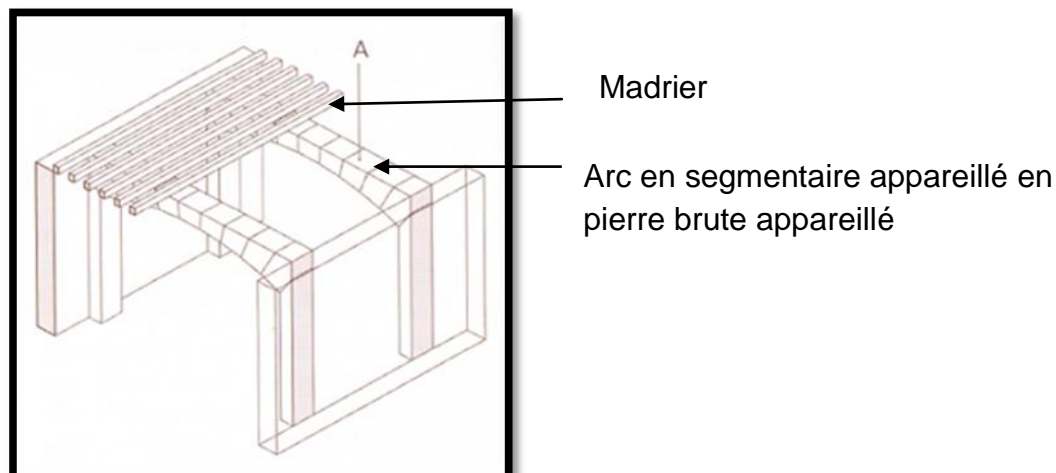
Planchers sur arcs en pierre brutes et poutres en bois
